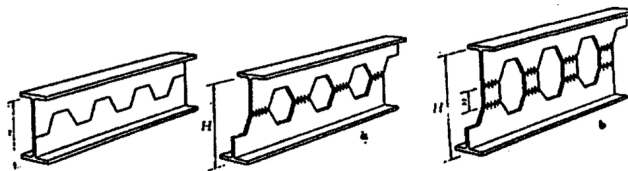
Vigas Aligeradas o Vigas Boyd
